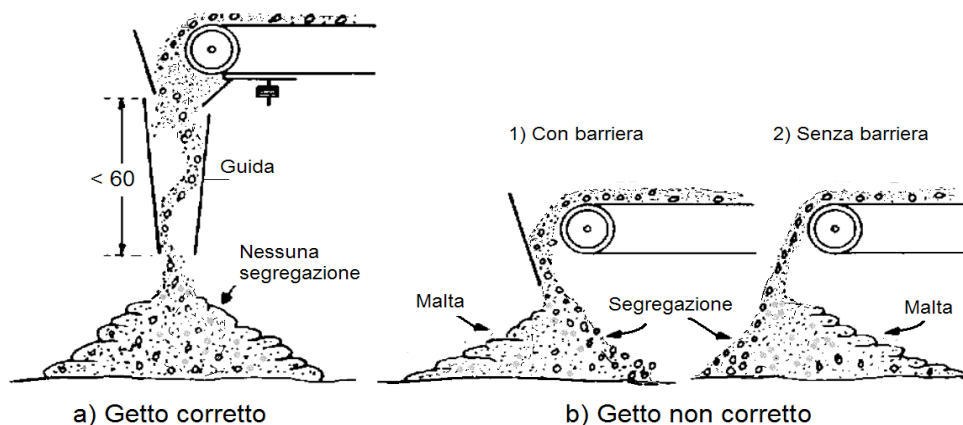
Esempi di getto di calcestruzzo con nastro trasportatore: a) getto corretto e b) getto non corretto. Nel caso b) si ha la separazione degli aggregati dalla malta cementizia. La barriera comporta soltanto il cambiamento di direzione della segregazione.
